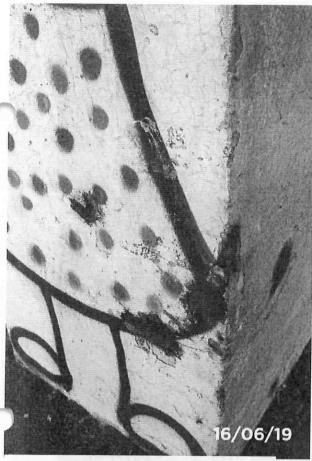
Detalhe de segregação do concreto, trincas, desplacamento do concreto do pilar, pontos aparentes de bolor, devido a infiltração de água no concreto.
